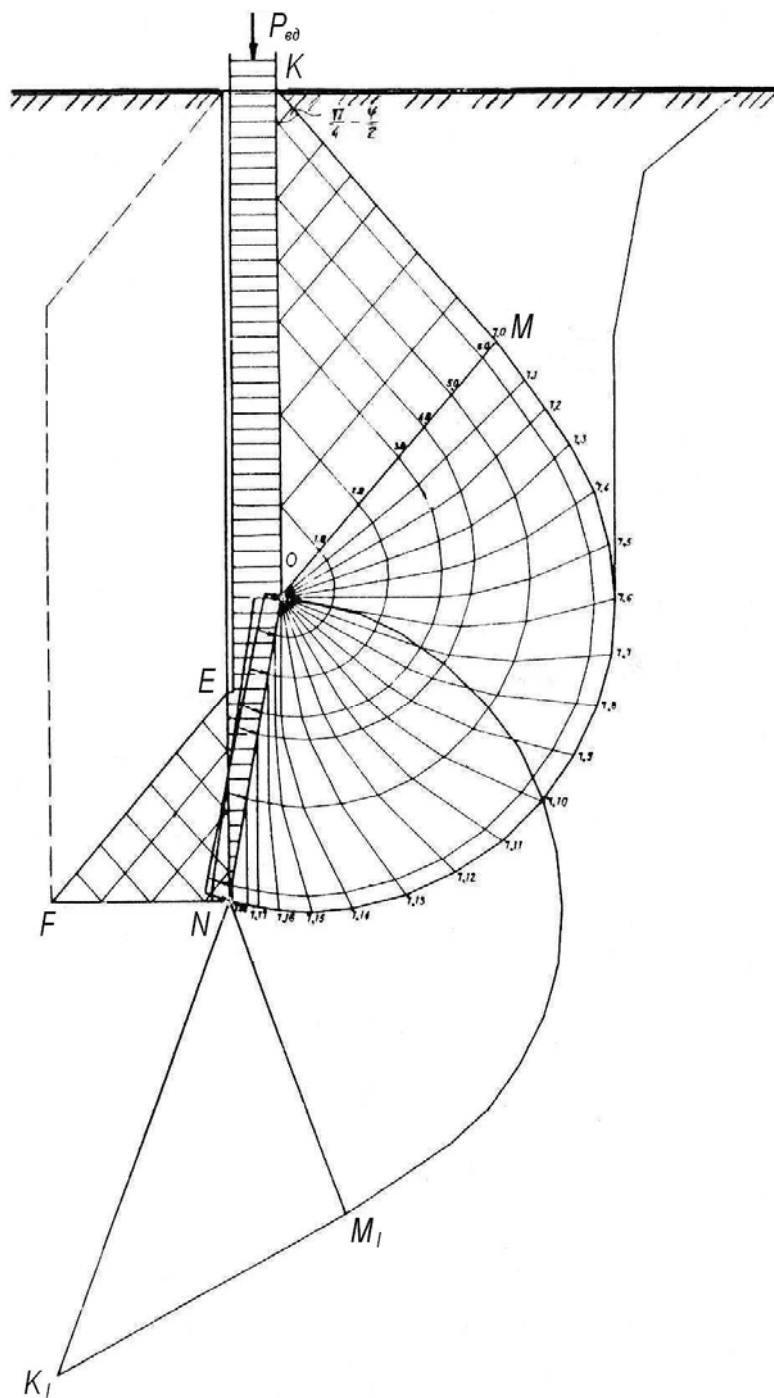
Схема развития областей нарушения грунта при вдавливании грунтоприёмной гильзы по А.В. Васильеву
